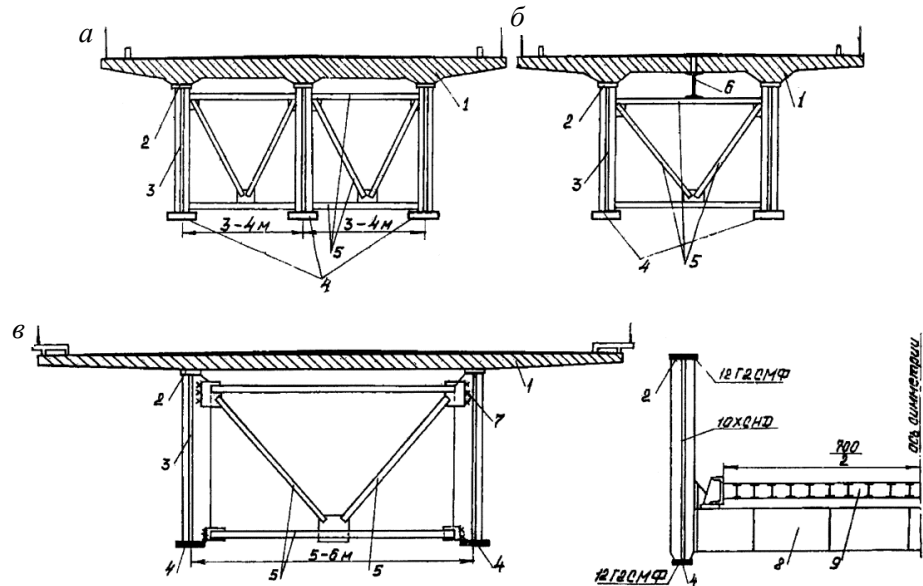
Поперечное сечение бисталежелезобетонных пролетных строений:
